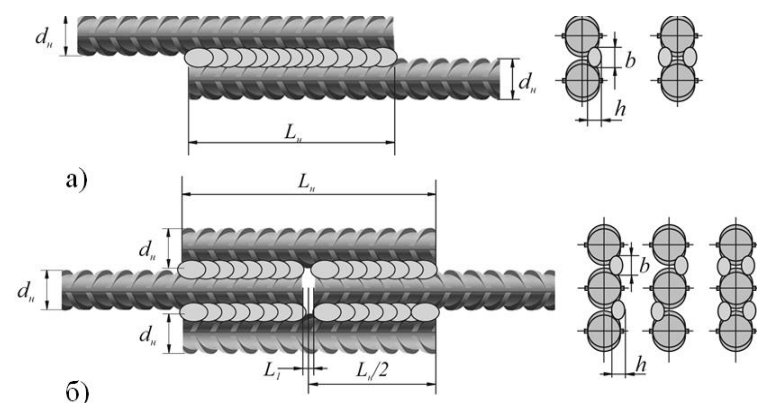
Сварные соединения арматуры: а – нахлесточные; б – стыковые
